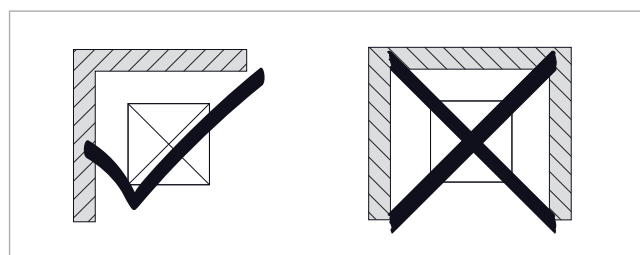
Condizioni di montaggio nelle vicinanze di pareti
